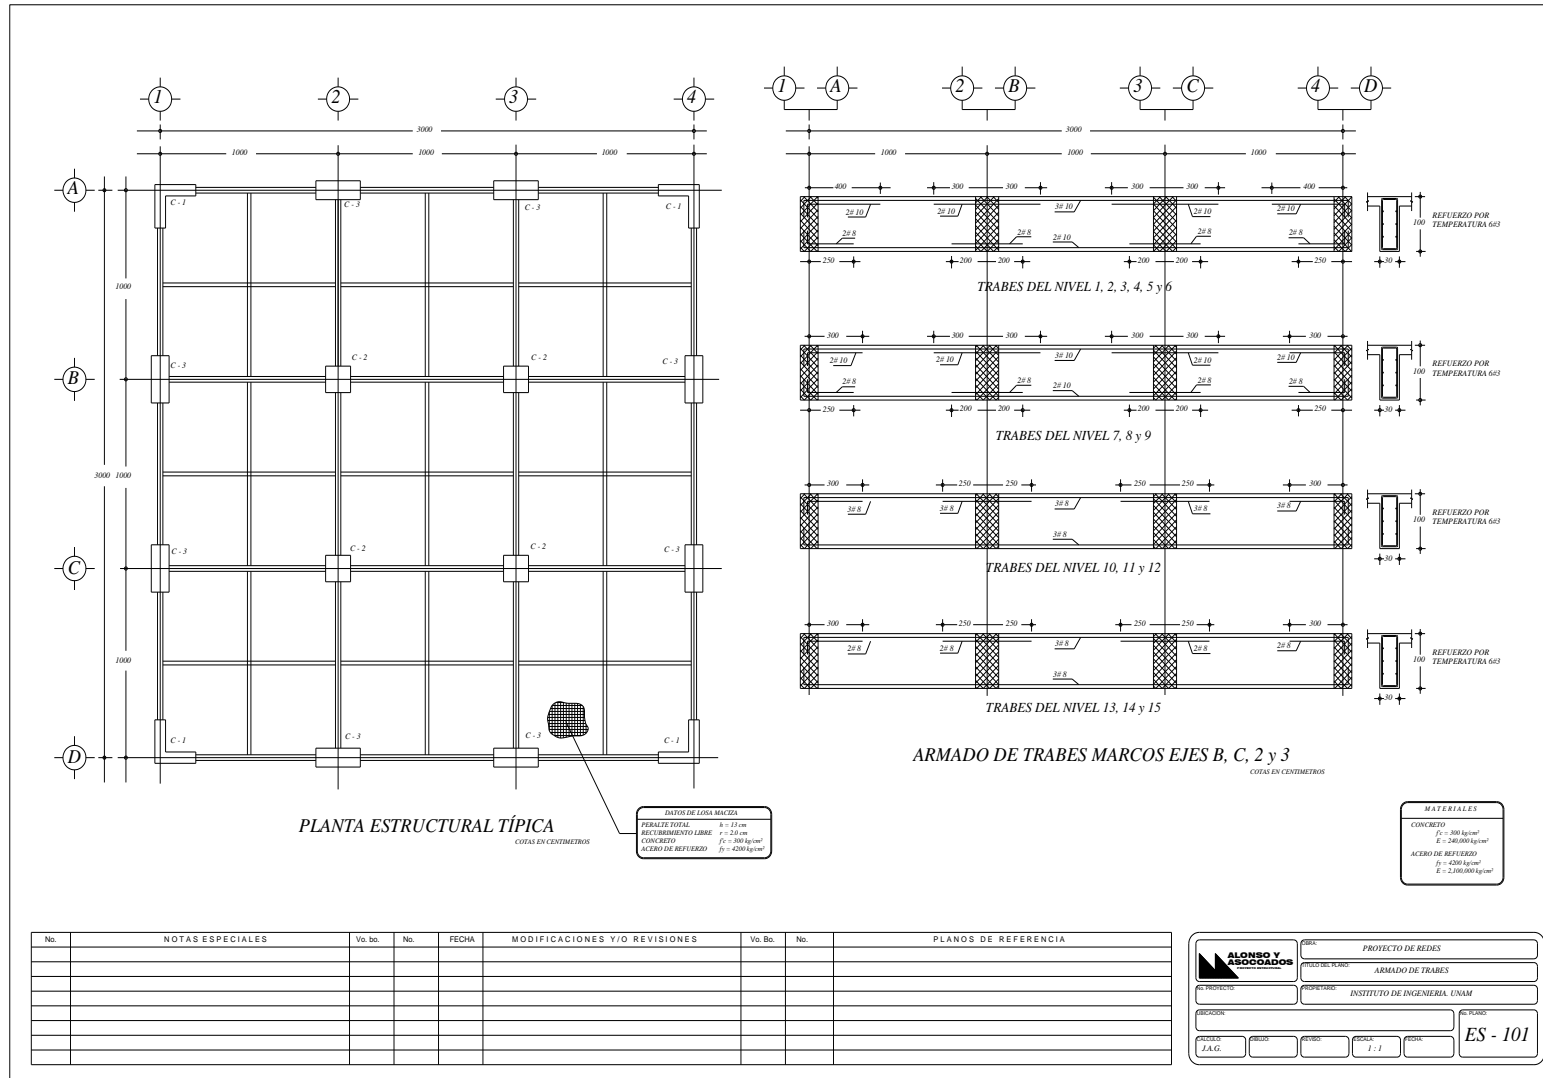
Detalles estructurales del edificio de 15 niveles diseñado con el RCDF-04
